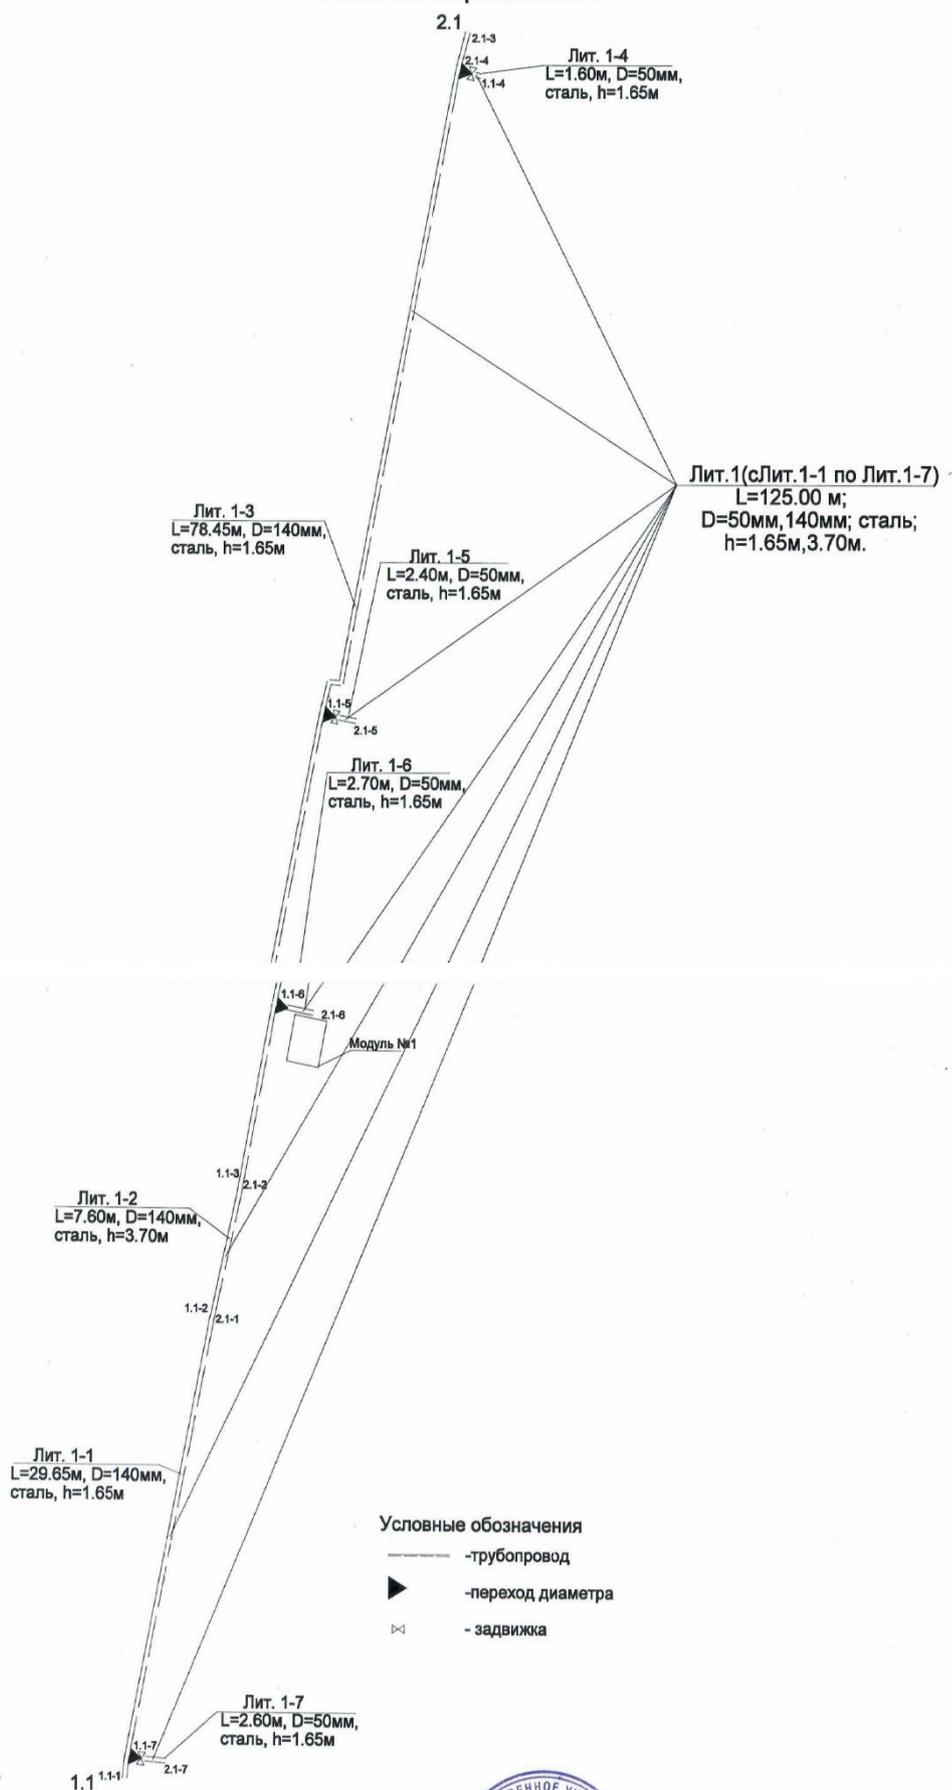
Схема тепловых сетей от модульной котельной № 1 ж/д
